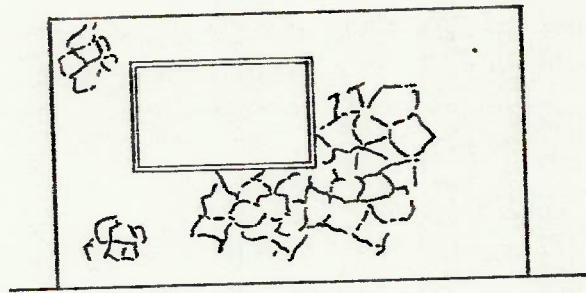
Fissuração da argamassa de revestimento provocada por sua retração
